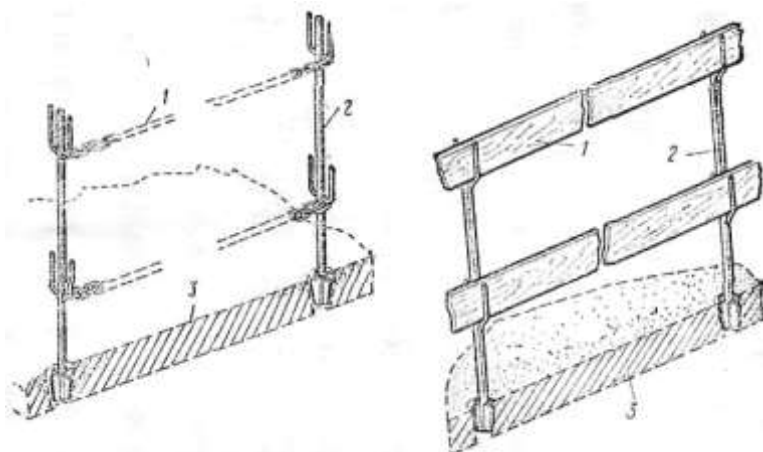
1 - цепь (доска); 2 - стойка; 3 - плита перекрытия
